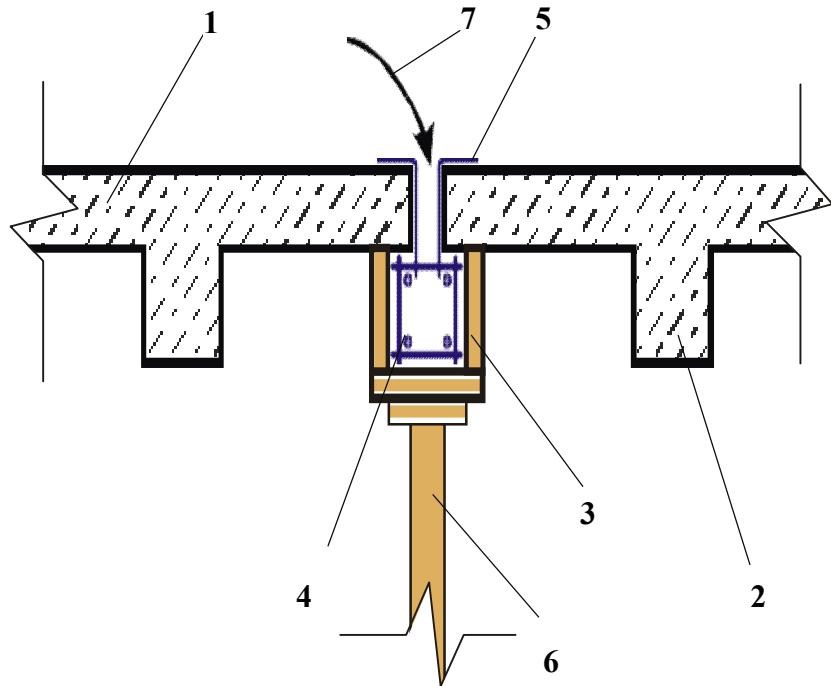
Посилення монолітного залізобетонного перекриття:
